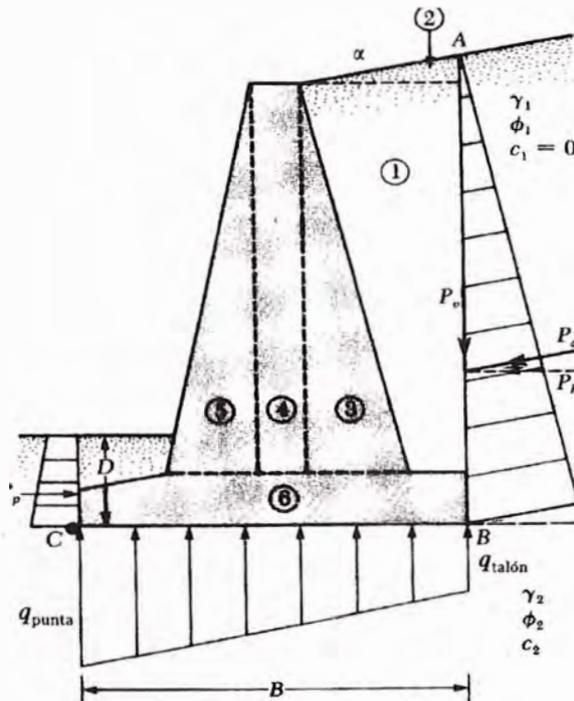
Esquema 02 y distribución de fuerzas de un muro gravedad
